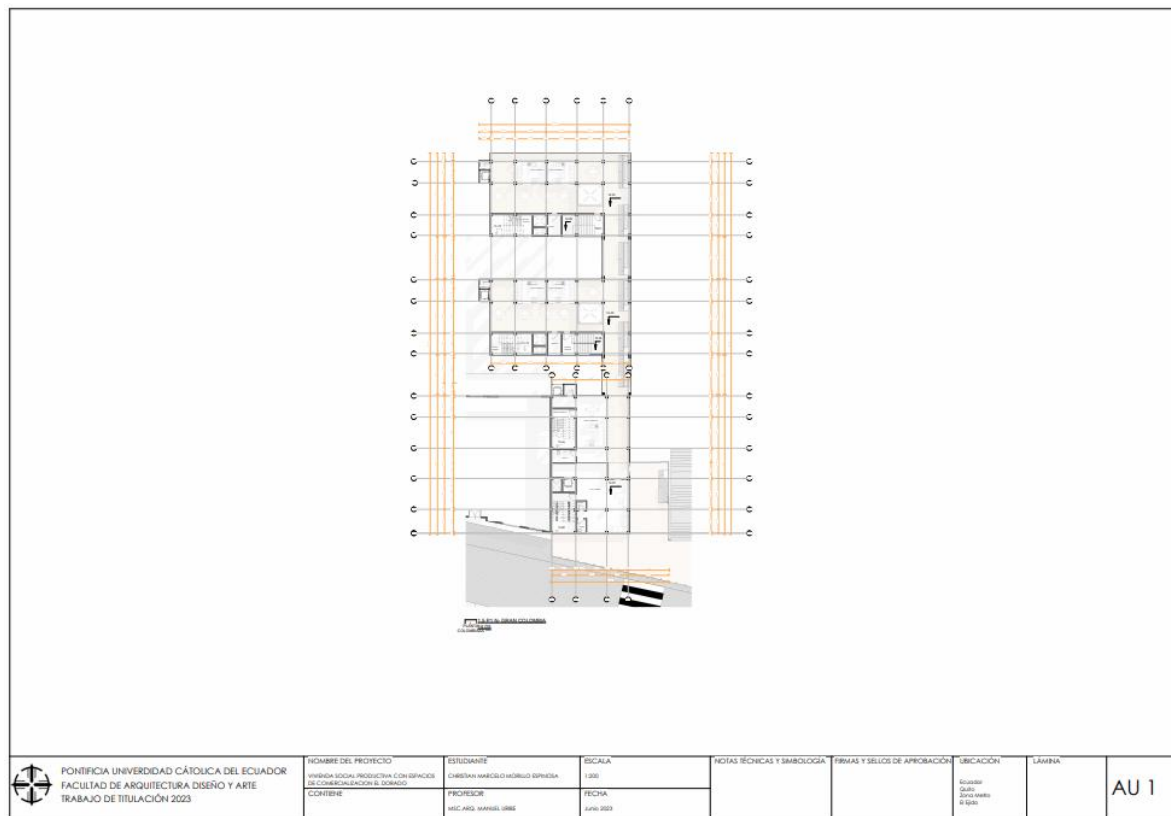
Primera y Segunda intervención- Planta Tipo 1 y 2. (Morillo C. 2023)
